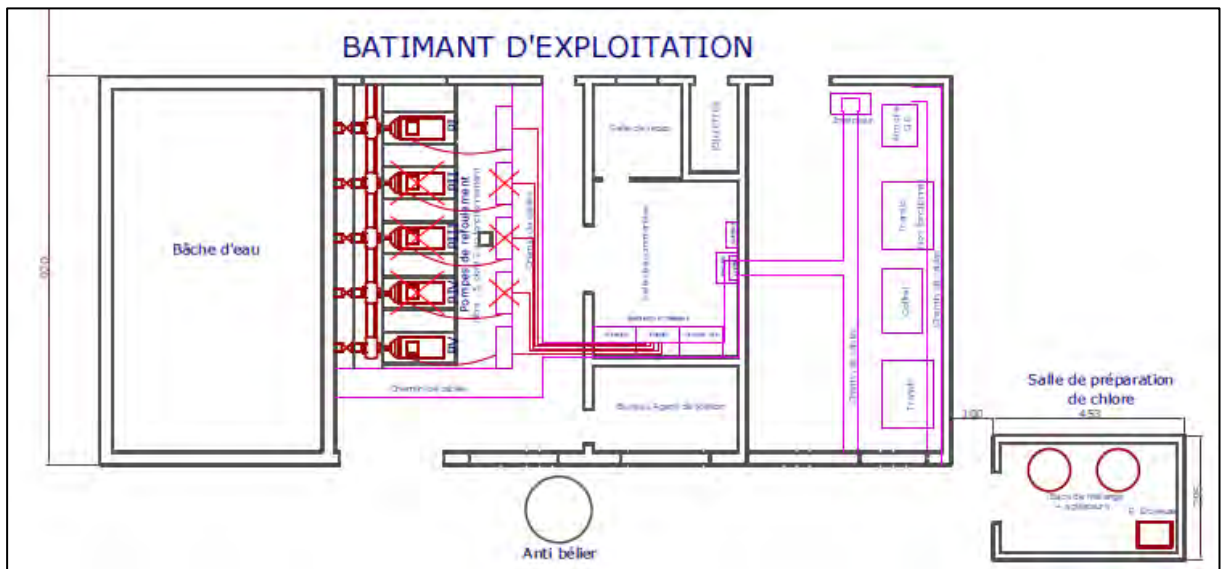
カキンボ送水ポンプおよび制御盤配置図
